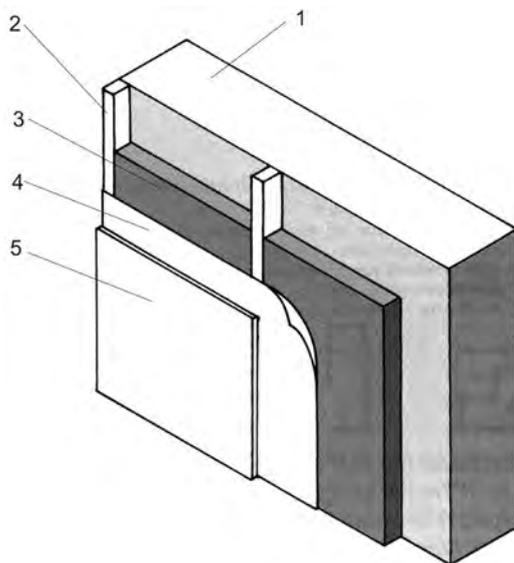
Внутренняя теплоизоляция наружной стены: 1 — наружная стена; 2 — вертикальные деревянные рейки; 3 — теплоизолирующие плиты; 4 — пароизоляционная прокладка; 5 — внутренняя обшивка
